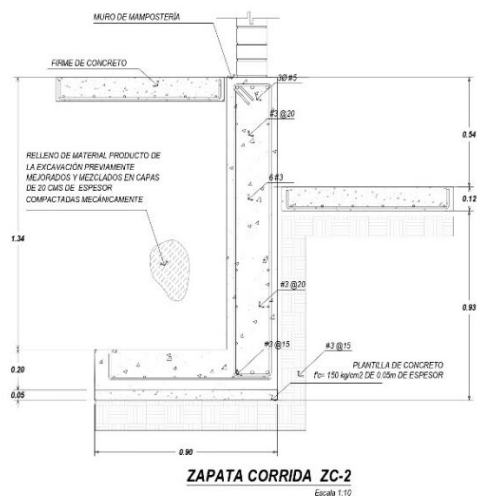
Detalles de zapata corrida. (Loretto, 2021).
